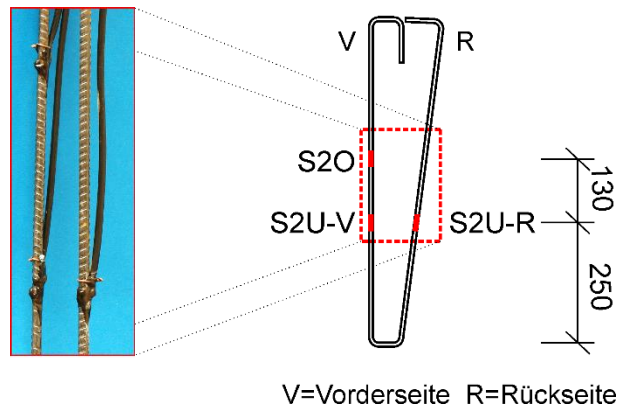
Lage Stahl-DMS auf Bügelbewehrung und Ausführung (exemplarisch)
